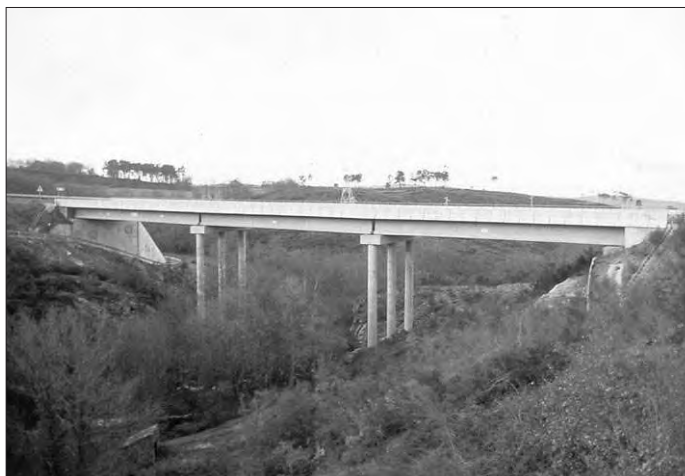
Os pilares da autovía das Rías Baixas, directamente sobre o cauce do río destruindo unha das pozas de Melón.
